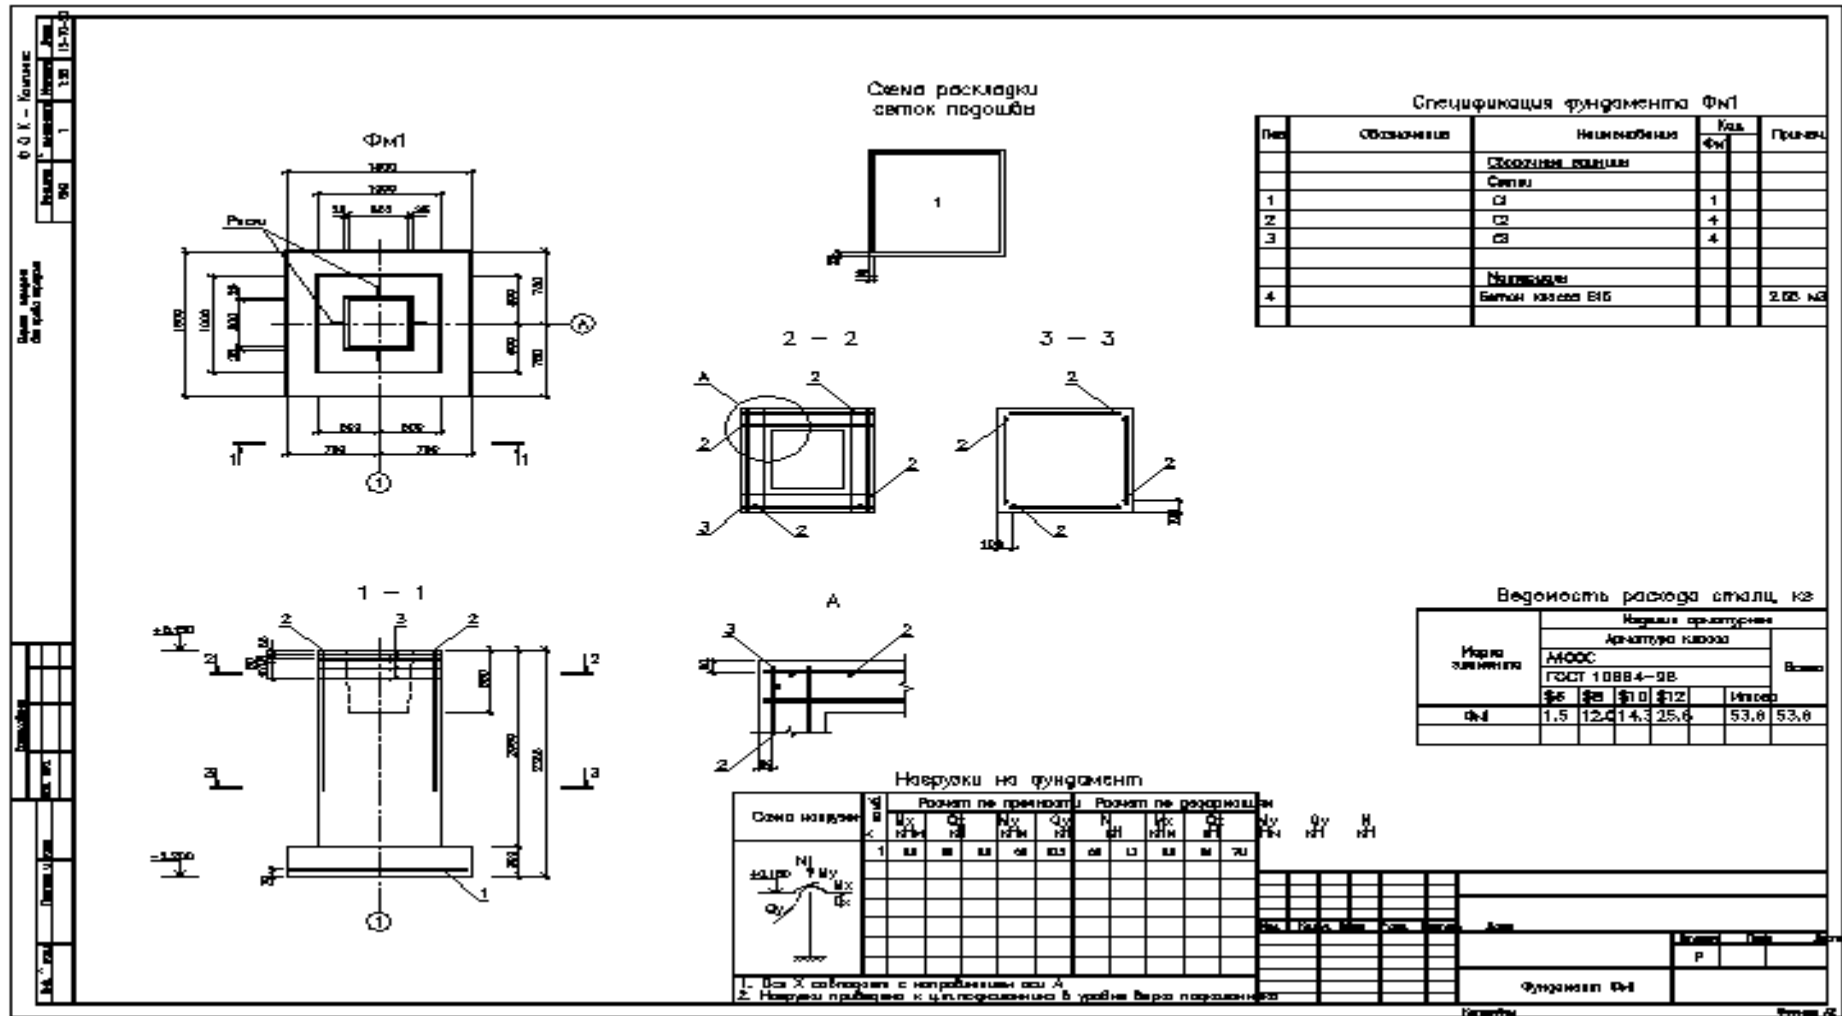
Фундамент ФМ1. Кресления рабочего проекта
